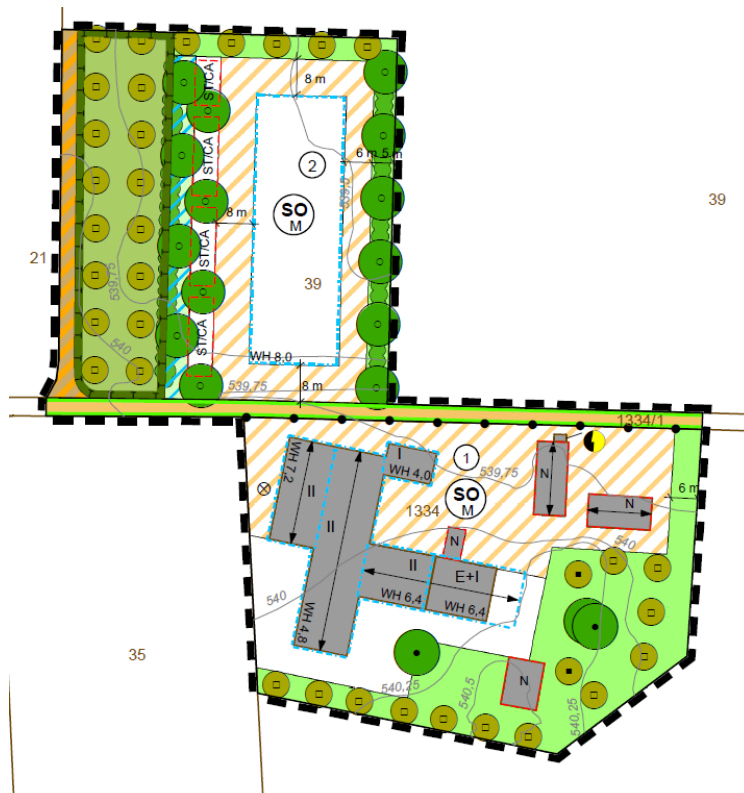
Bebauungsplan "Sondergebiet Metallbau Forst", Stand 12.11.2019
